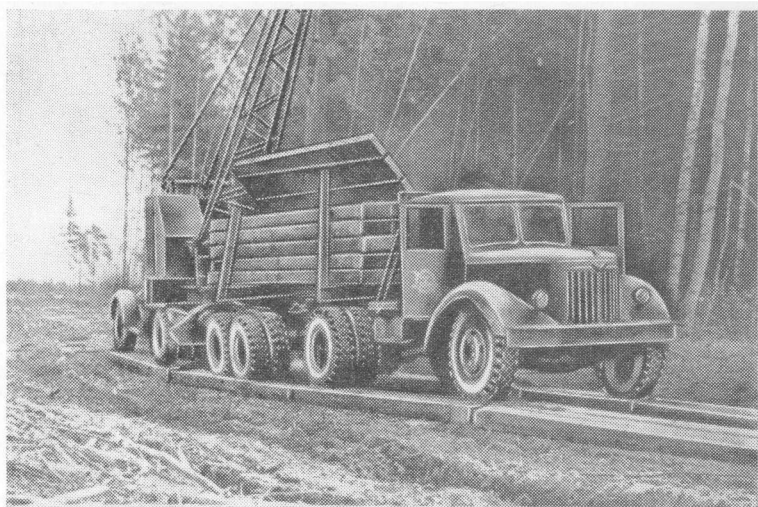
Разработка деревянного щитового покрытия автомобильным краном
